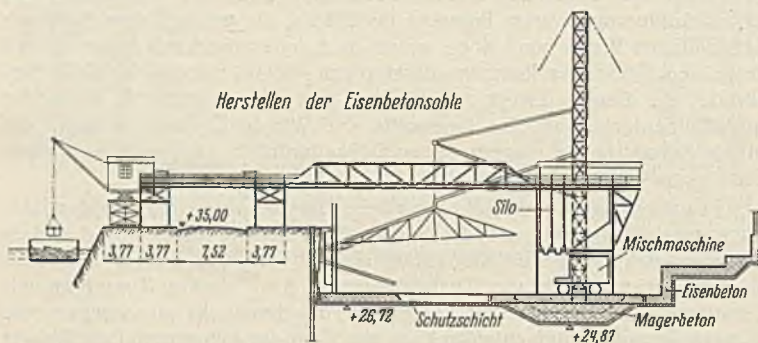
Baustelleneinrichtung. Vorschlag II. Beton-Gießanlage.
